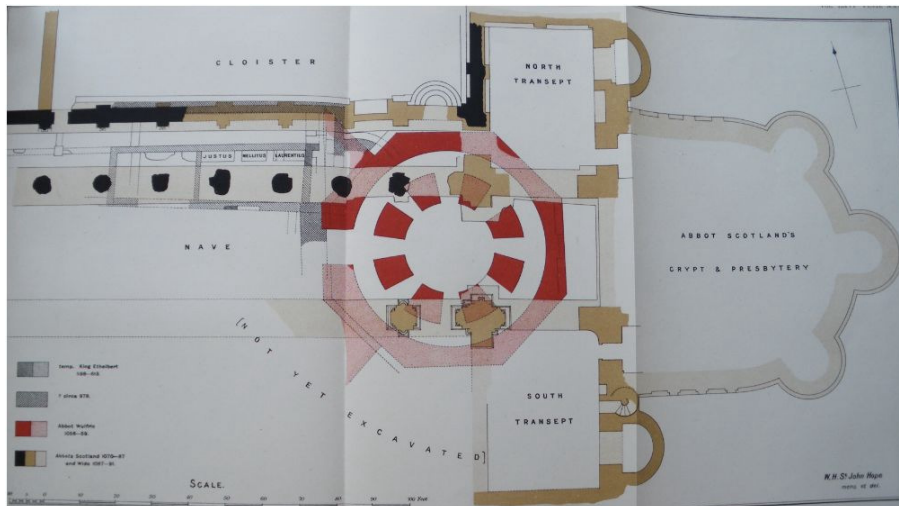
Grundriss, St. Austin Abbey, zweite Hälfte 10. Jh.
